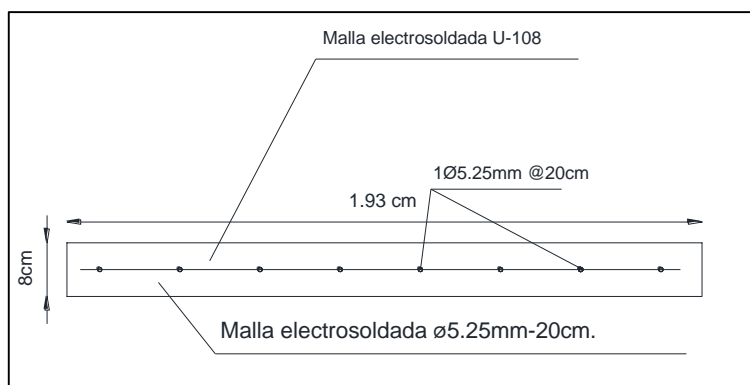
Esquema de sección transversal del muro portante de hormigón diseñado.
